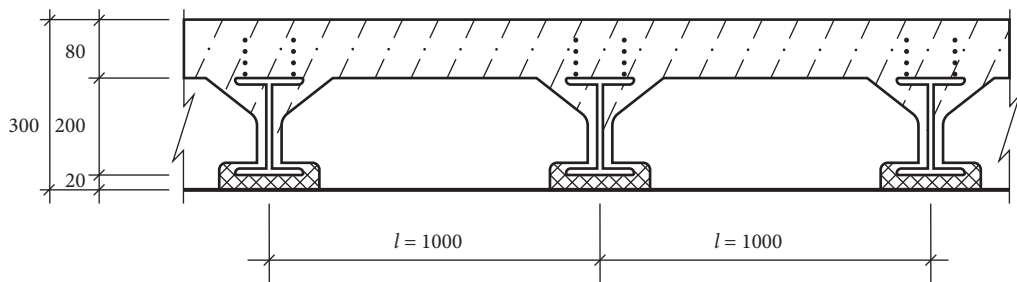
Перекрытие с легкобетонными вкладышами и монолитной плитой
